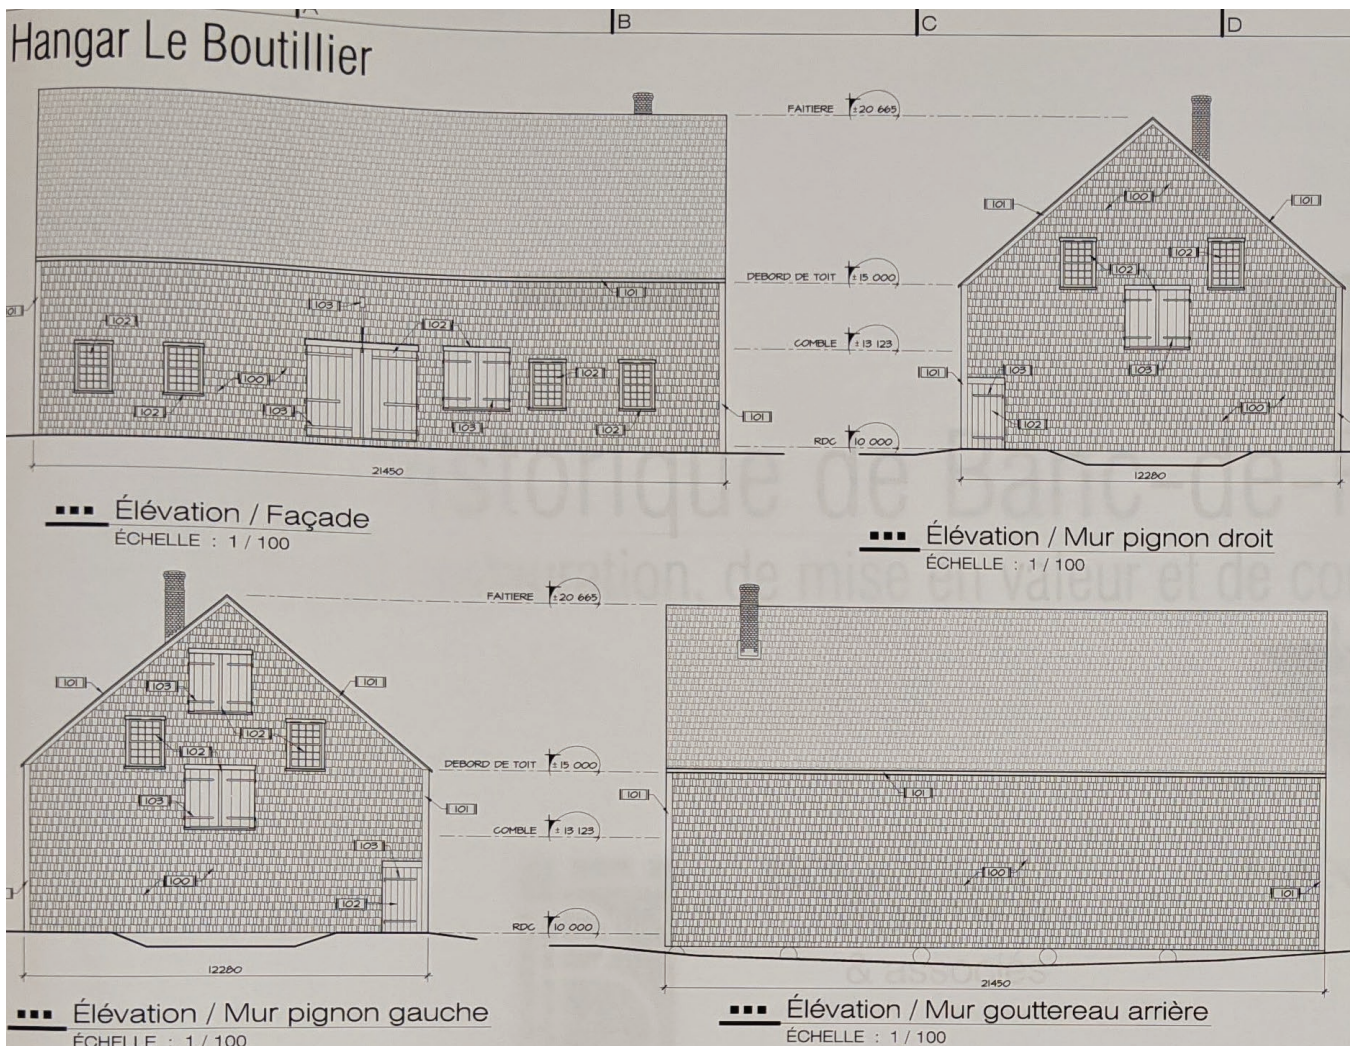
Plan pour la restauration du hangar en 2005 réalisés par Boudreau Fortier et associés, Bergeron Gagnon et Pierre Bourdages, architecte.
